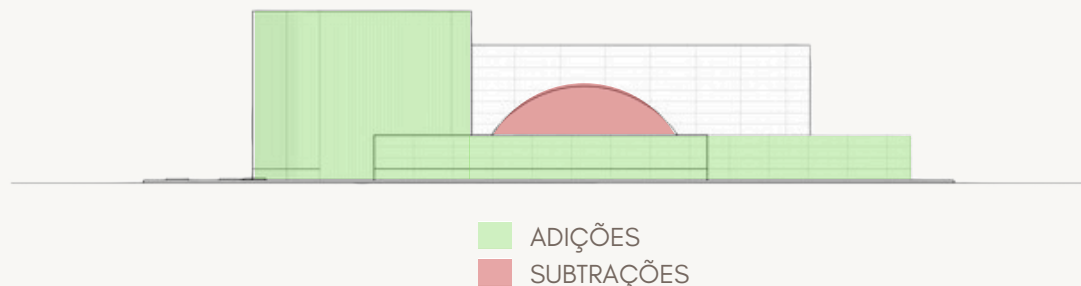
e 41: Fachadas da edificação. ArchDaily, modificado (2024)
